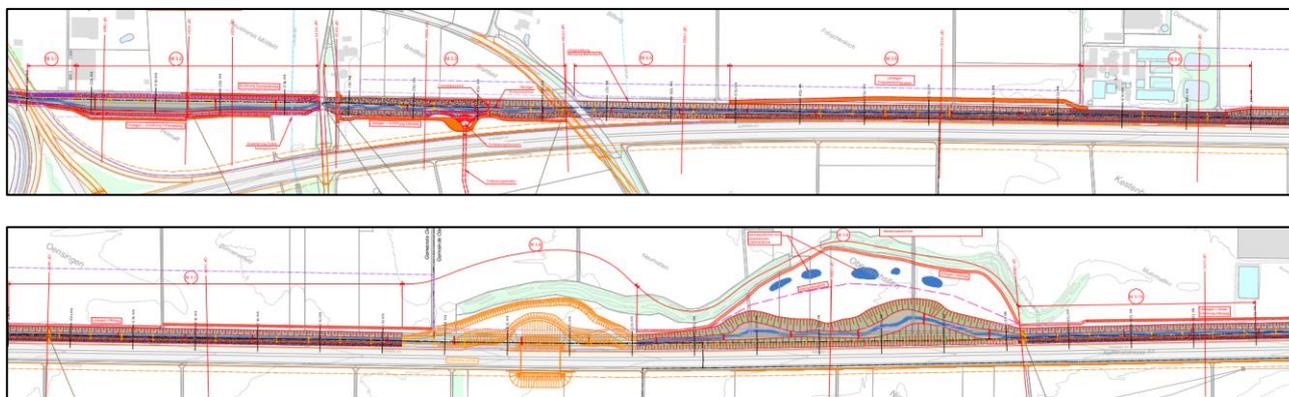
Ausschnitt Situationsplan (oben: Abschnitt 3-1, unten: Abschnitt 3-2).
